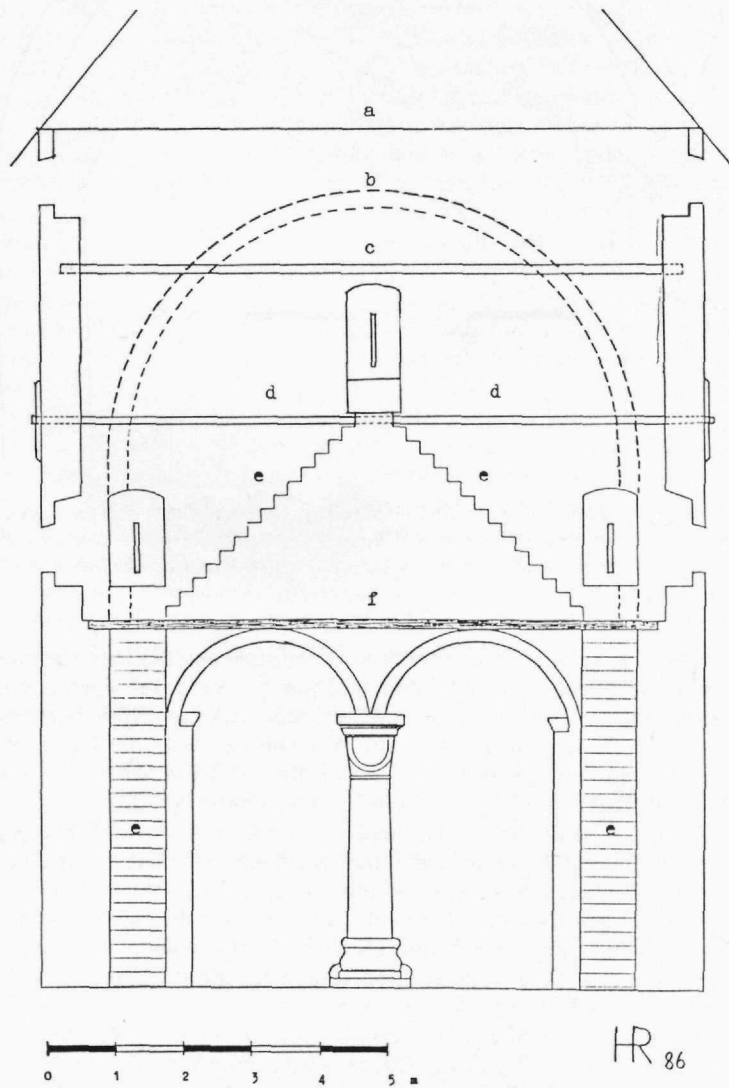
Versuch einer Rekonstruktion der alten Kirche mit Blick auf die Westempore: a) Dachgeschoß, b) nachträglich eingebautes Tonnengewölbe, c) ursprüngliche Flachdecke, darüber Obergeschoß mit Schießcharten, d) durchgehende Mauererschließen, e) Stufen im breiten Mauerwerk, f) Emporenboden.
